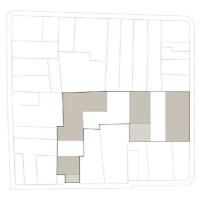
Planta Volumetría 3 Fuente: Autores, 2022
